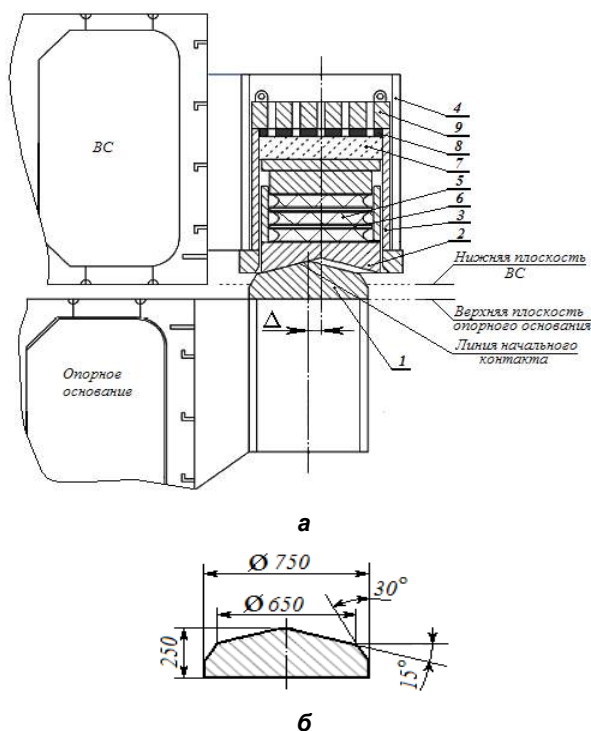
Схема конструкции стыкового устройства, верхняя часть которого расположена на верхнем строении, а нижняя – на опорном основании: а – положение частей устройства непосредственно перед стыковкой (перед принудительным совмещением стыкуемых элементов ВС и опорного основания); б – геометрия и размеры конусного элемента нижней части устройства, использовавшегося при монтаже моноблоков ППБУ “Полярная звезда”.
